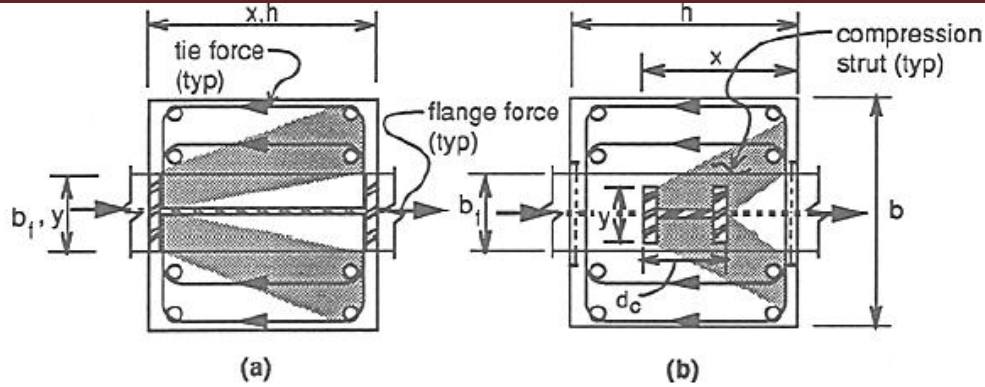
Mecanismo de transferencia de fuerzas horizontales fuera del panel de acero por;
